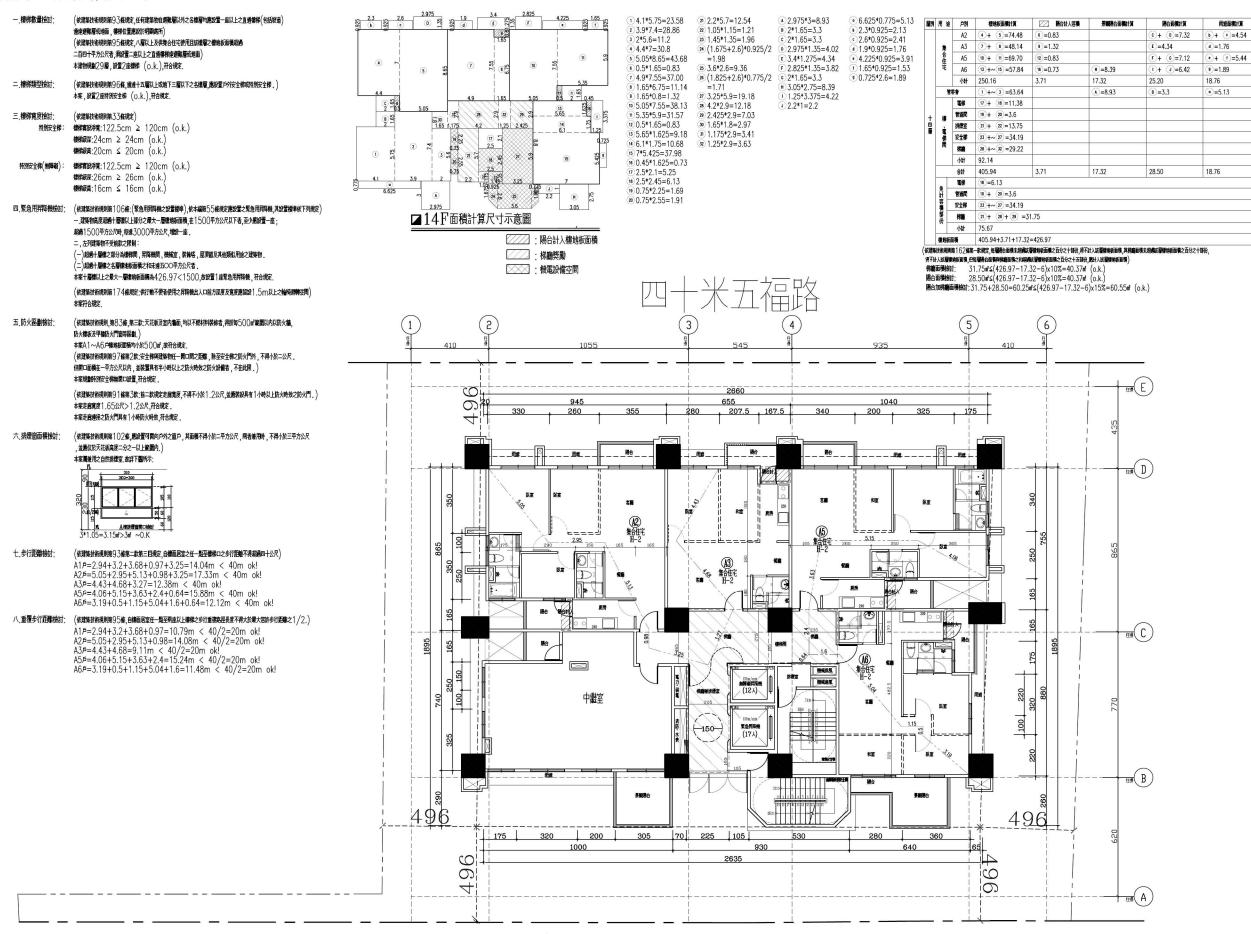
地上 14 層平面圖 (比例尺 1/200)
